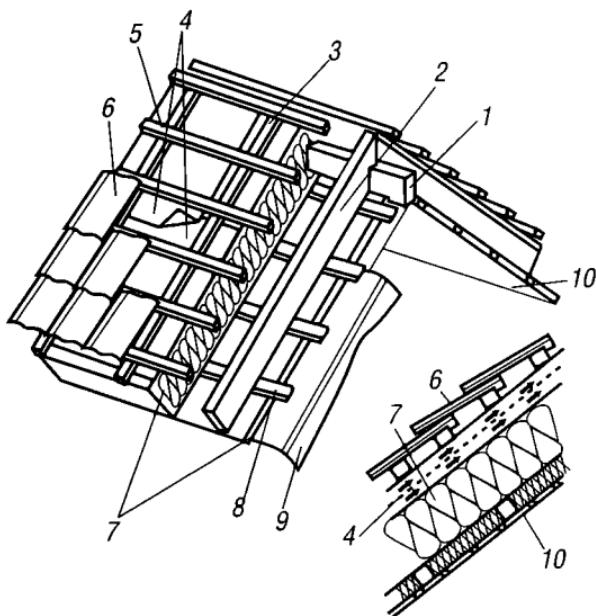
Устройство кровли с вентиляционными зазорами (обрешетка под черепицу, стрелки показывают движение воздуха):
